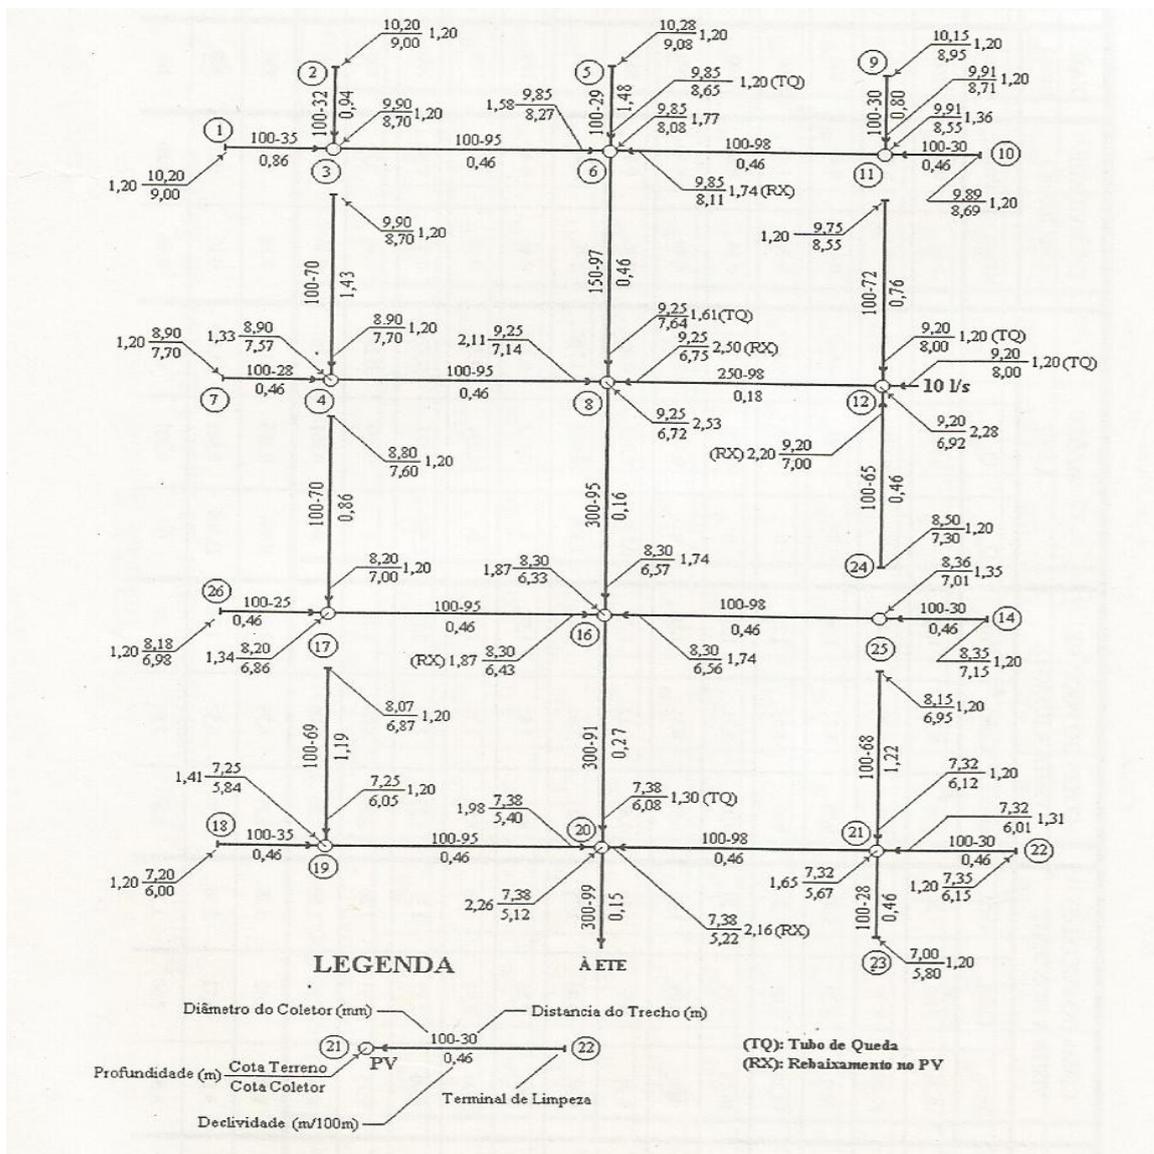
Planta construtiva, sistema de esgotamento sanitário.
